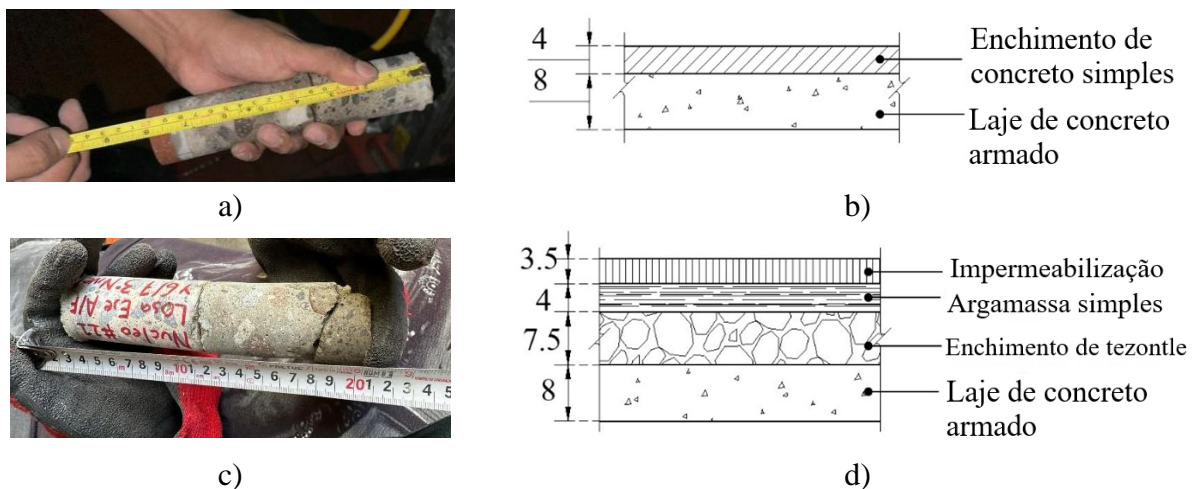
Sistema construtivo em lajes de pavimento e laje de cobertura; a) materiais encontrados em laje de pavimento; b) espessuras de materiais em laje de pavimento; c) materiais encontrados em laje de cobertura; d) espessuras de materiais em laje de cobertura. Unidades em cm.
